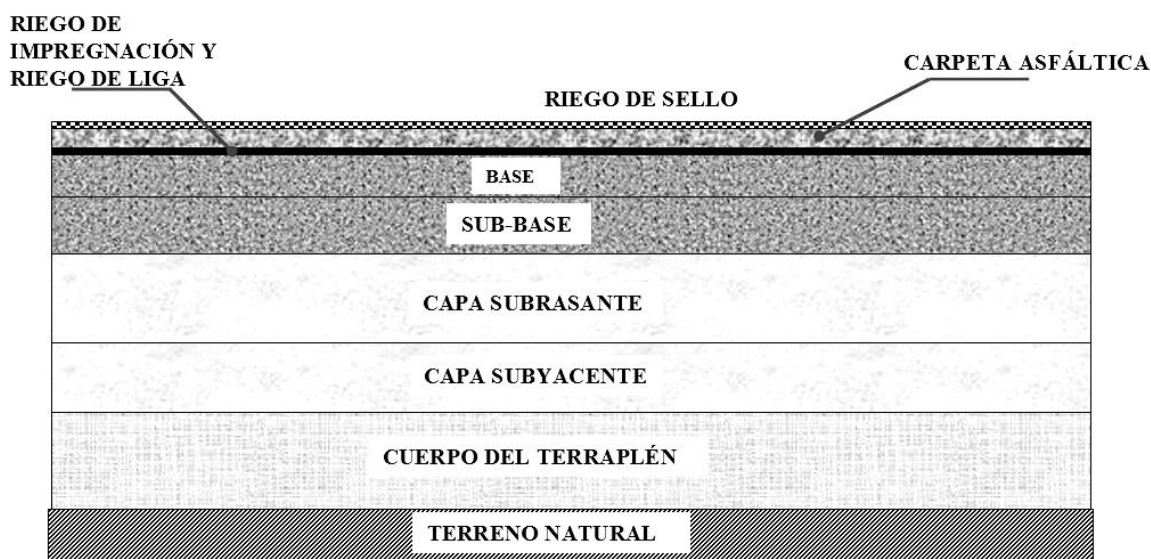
Sección estructural típica de un pavimento flexible (asfáltico).
